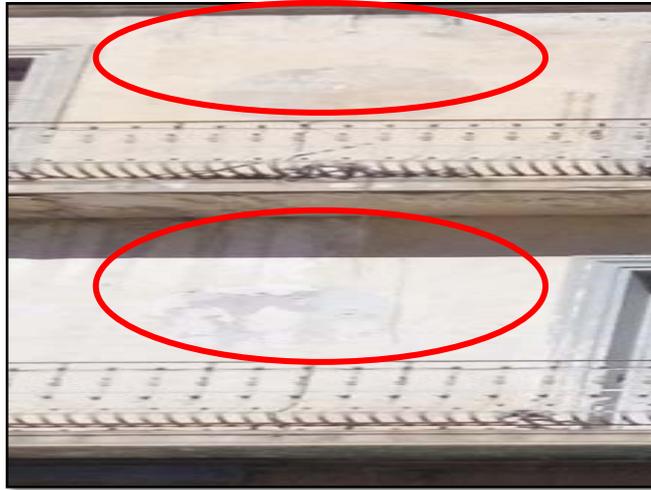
Fissure vertical superficielle au niveau des murs de façades (source : l'auteur)
